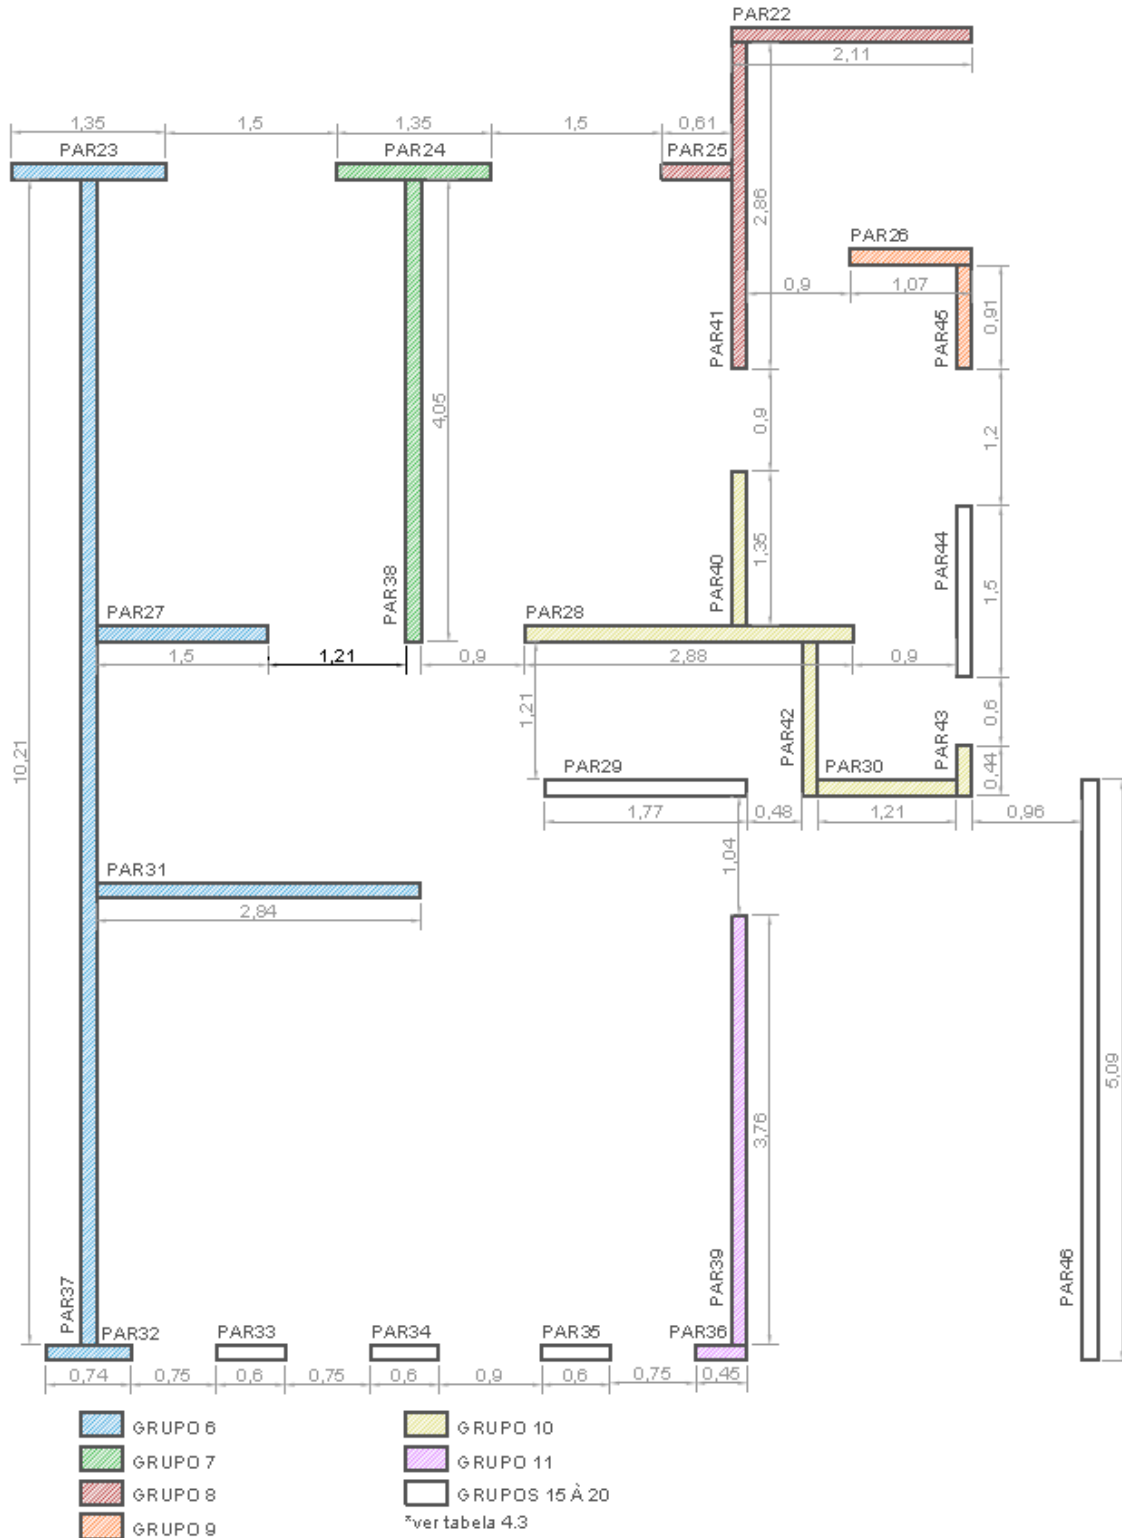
4 Separação das paredes em grupos isolados, Pavimento Térreo.
